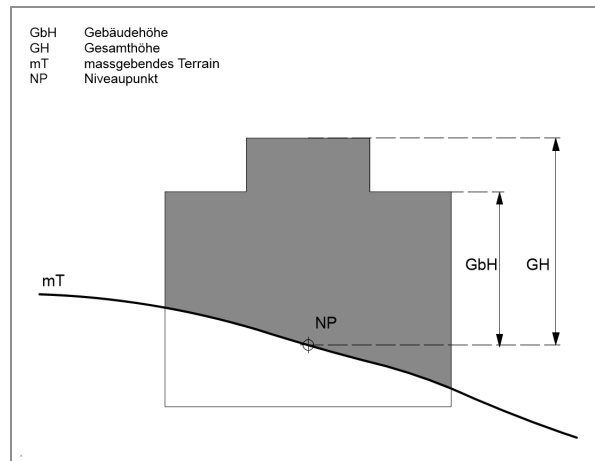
Gesamt- und Gebäudehöhe Flachdach
